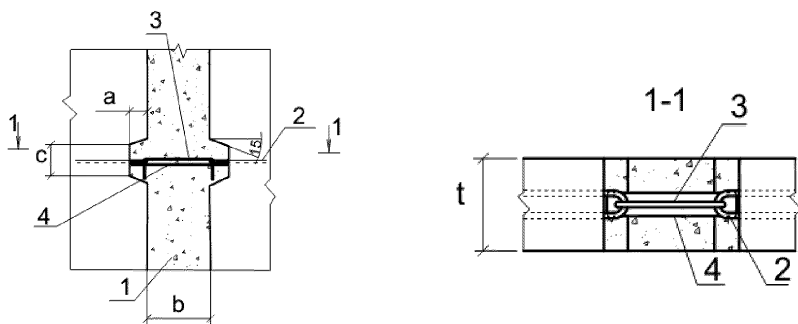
Соединение двух панелей. 1 – бетон замоноличивания; 2 – петлевые арматурные выпуски; 3 – соединительные скобы; 4 – соединительная пластина; а – 70–80 мм; b – 100–120 мм; c – 150–160 мм; t – толщина стены (140–250 мм).
